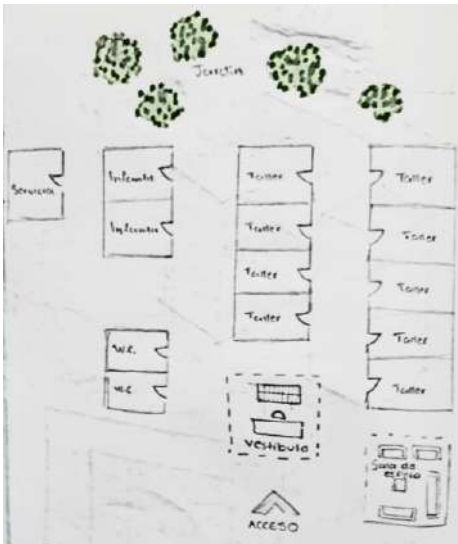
Boceto de planta arquitectónica, propuesta 1. Fuente propia.
